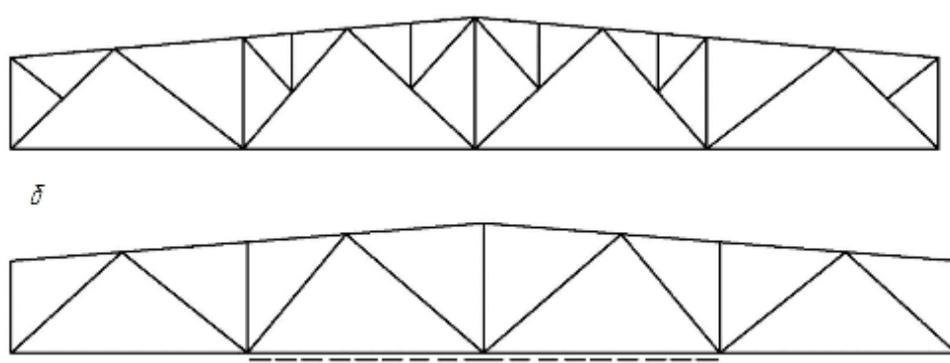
Усиление узла фермы путем изменения конструктивной схемы с помощью 1 — установки дополнительных стоек, 2 — установкой затяжки по нижнему поясу
